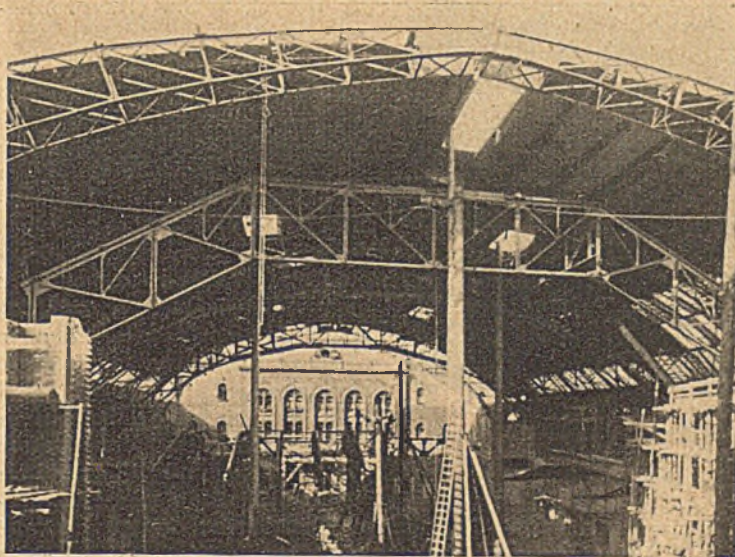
Einbau der neuen Kuppelträger unter dem alten Hallendach.
